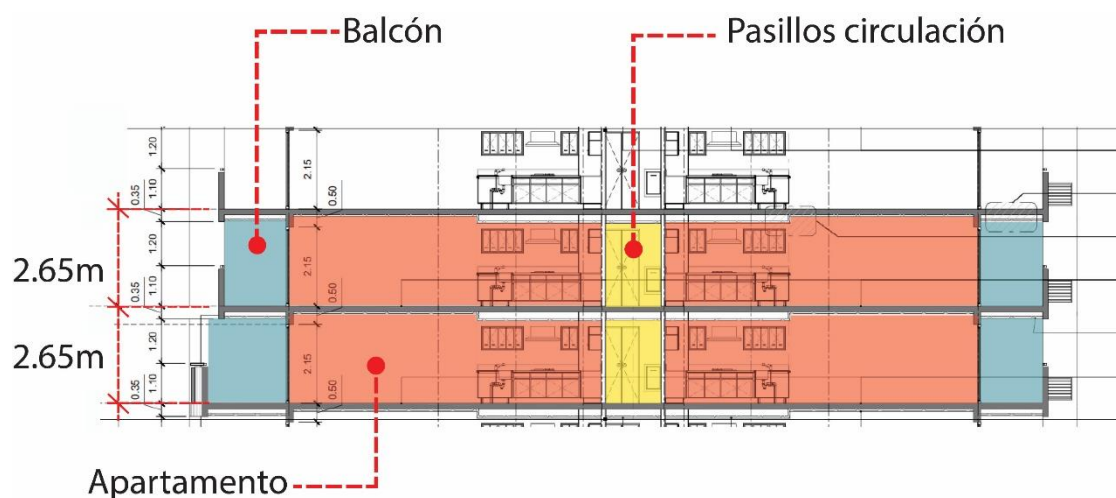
Detalle Corte de apartamento típico. Fuente: Elaboración propia a partir de planos suministrados por la Empresa Arquitectura y Diseño del Arq. José Salinas
